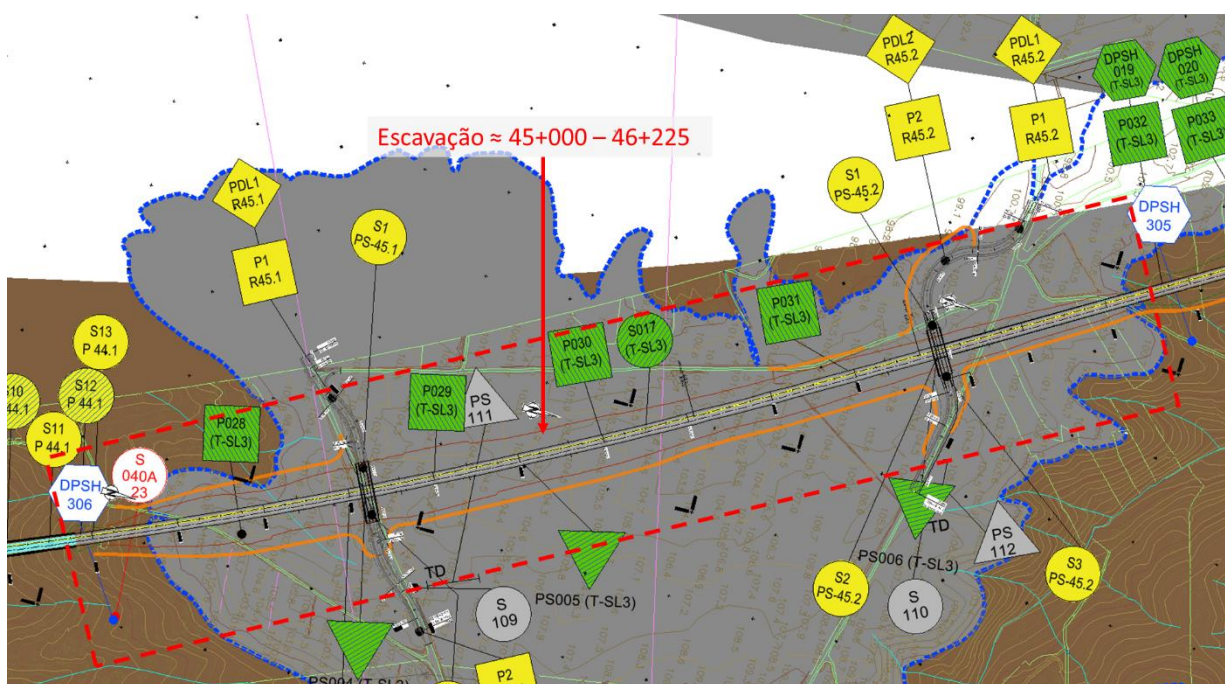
Representação em planta do trecho de escavação situado entre o PK 45+000 e 46+225
